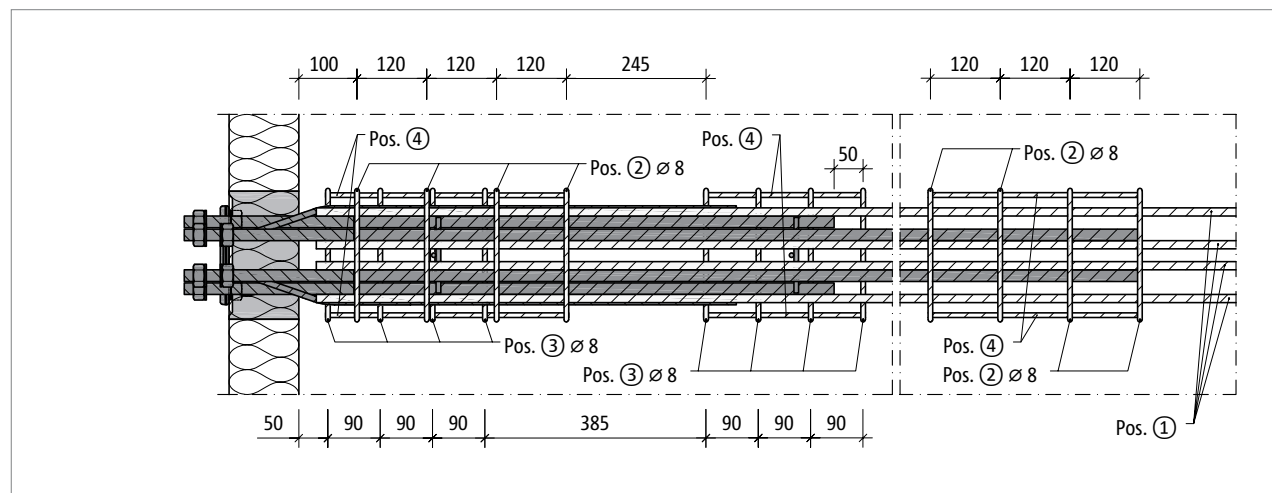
Schöck Isokorb® XT Typ SK-MM2: Bauseitige Bewehrung, Grundriss
